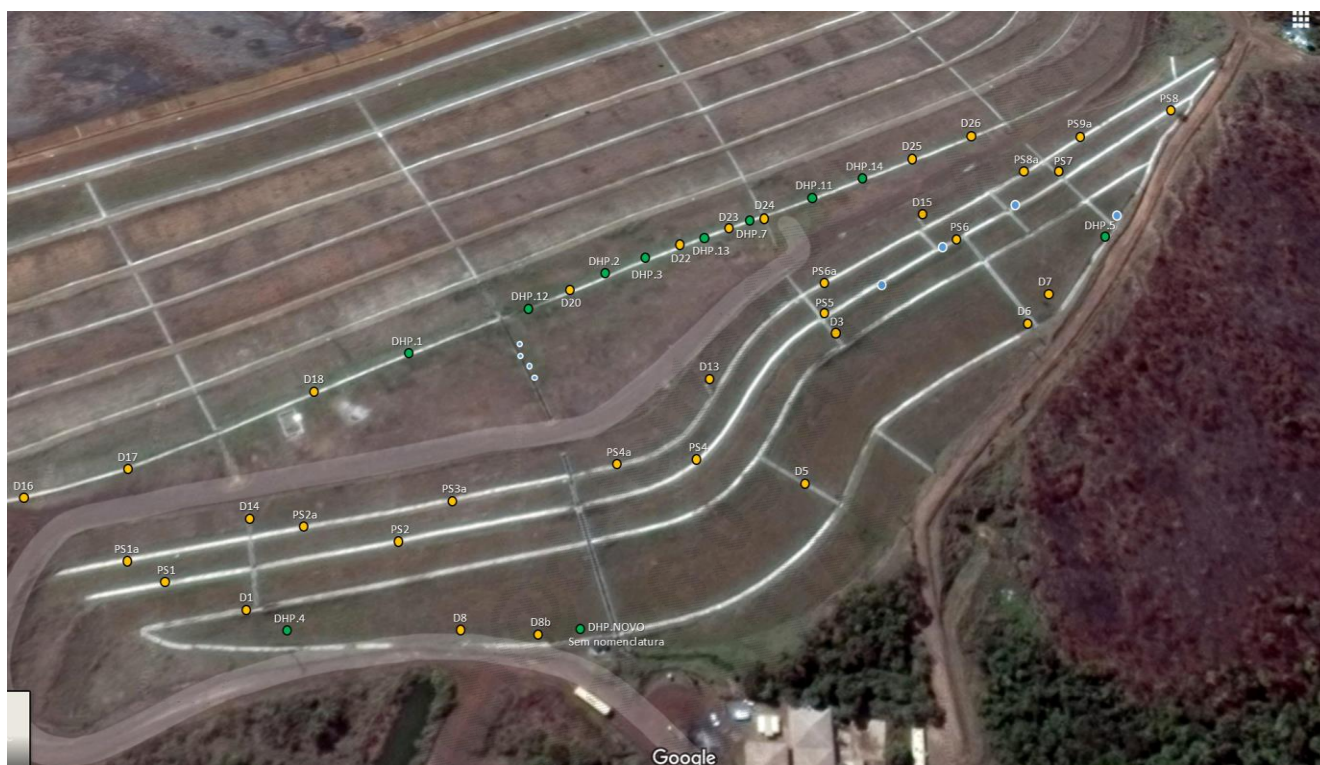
Planta de locação dos medidores de vazão conforme cadastro da equipe de operação.
